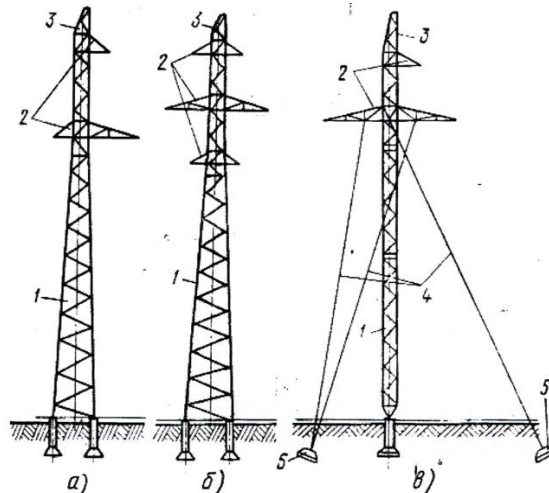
Промежуточные металлические опоры: а, б – свободностоящие одно- и двухцепная башенного типа; в – одноцепная с оттяжками
